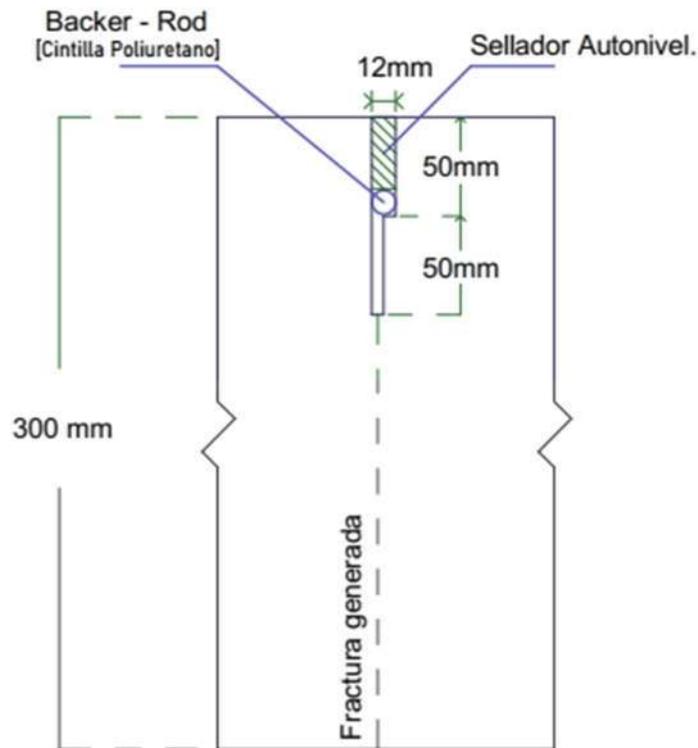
Detalle de las juntas de contracción. Elaboración propia [Zachery R.]
